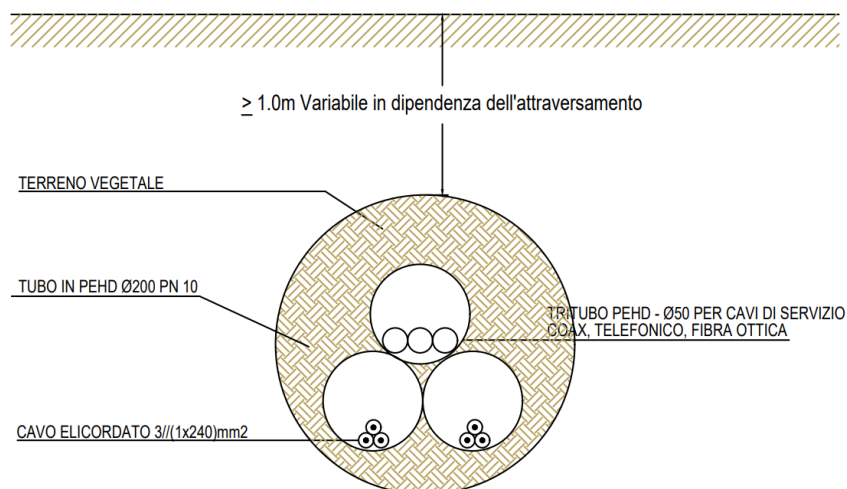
Sezione tipo T.O.C. – Attraversamento con sonda teleguidata
